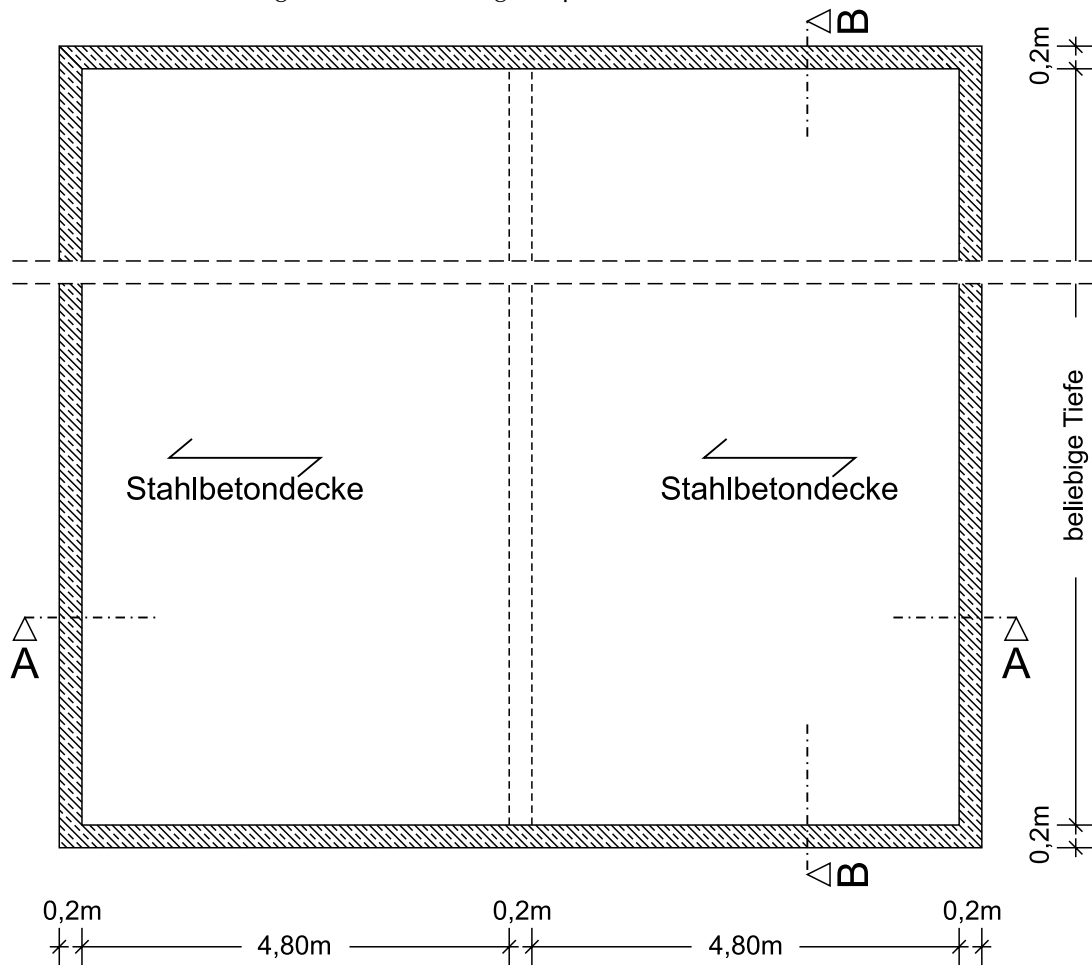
Grundriss des Bemessungsbeispiels
